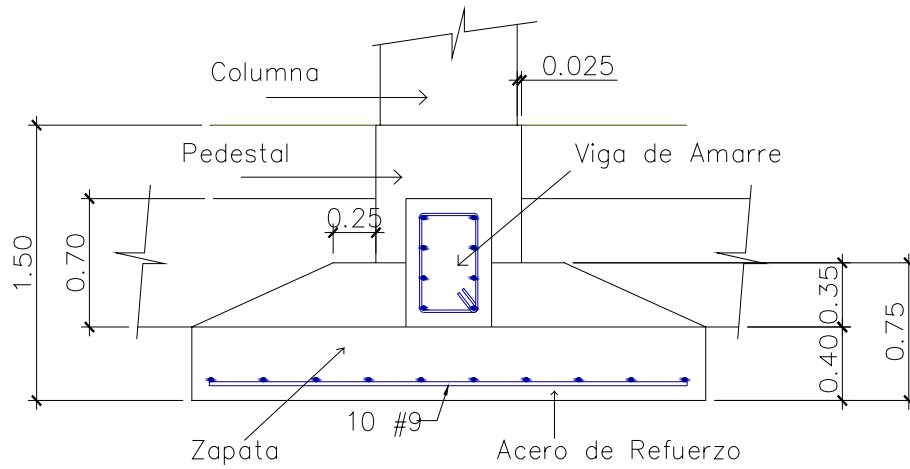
Sección de la zapata # 3.Tabla 1. Dimensiones y armado de zapatas.PLANILLA DE ZAPATAS DE LA Z-3 HASTA LA Z-14
